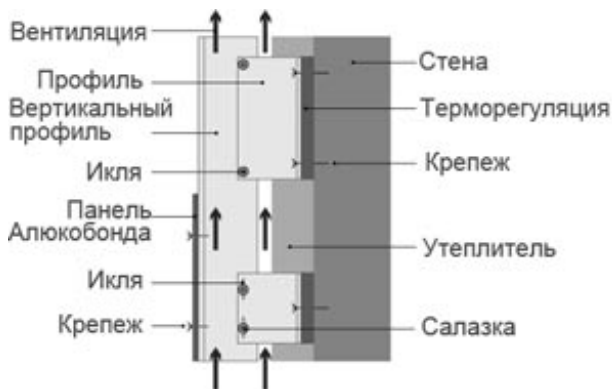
Схема вентилируемого фасада из панелей Alucobond
